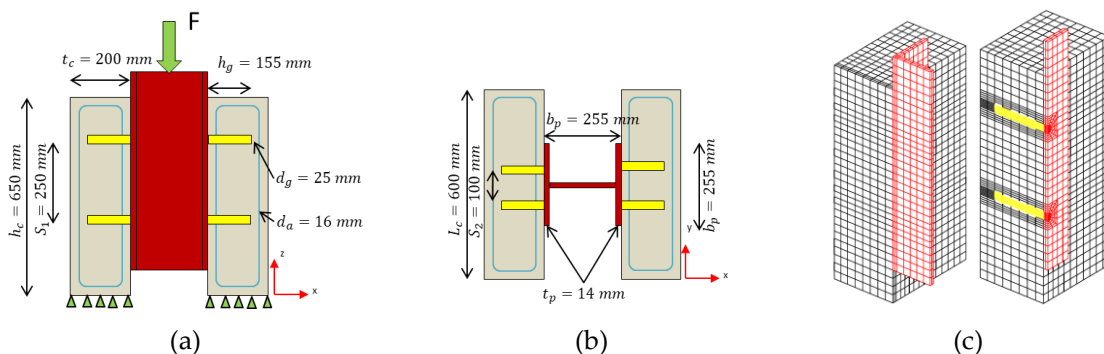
(a) Schéma de la section xz de l'essai push-out ; (b) Schéma de la section xy de l'essai push-out (c) Maillage (à gauche) et coupe du maillage au droit des goujons (à droite) de l'essai push-out
